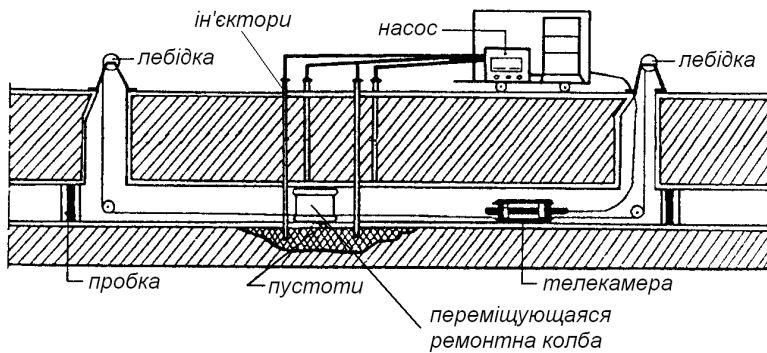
Схема ін'єцювання зовнішньої поверхні трубопроводу
